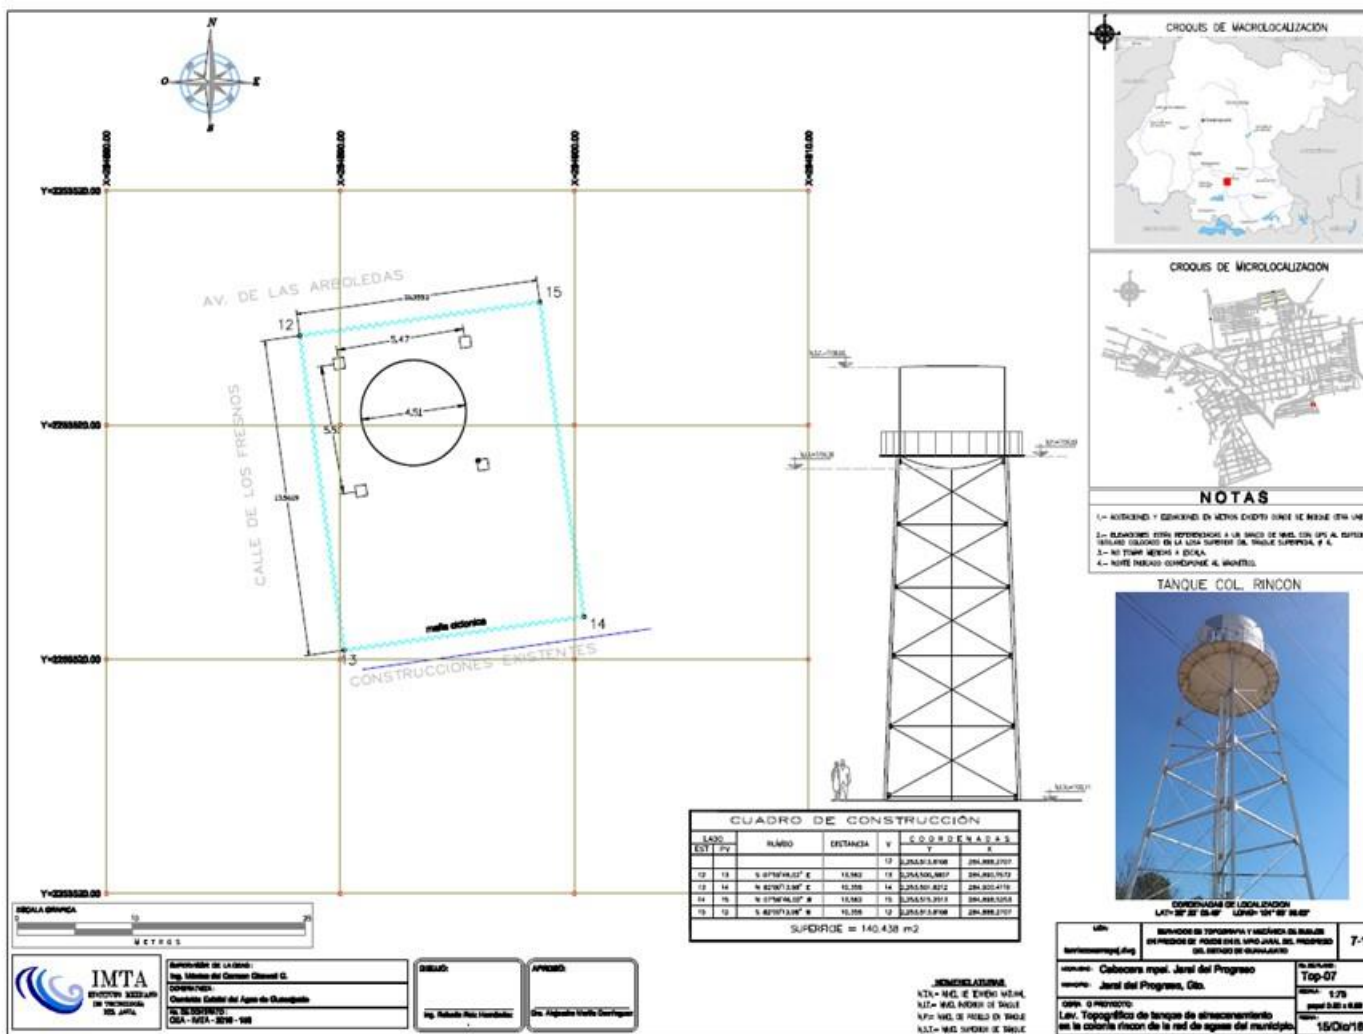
Levantamiento Tanque Hacienda del Rincón (Ver anexo de planos para más detalle)
